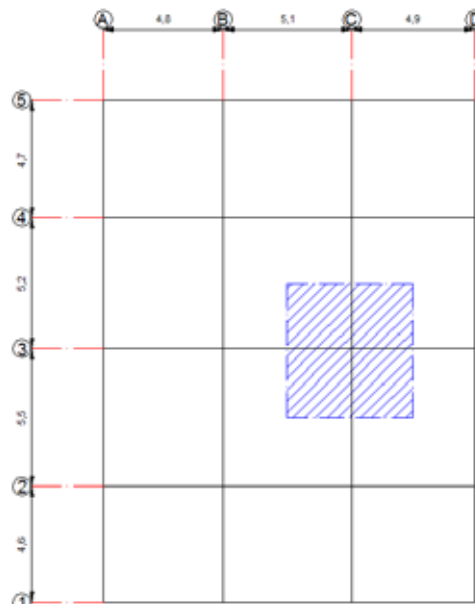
Área colaborante para la columna C3. Fuente: Caiza, Pablo 2018
